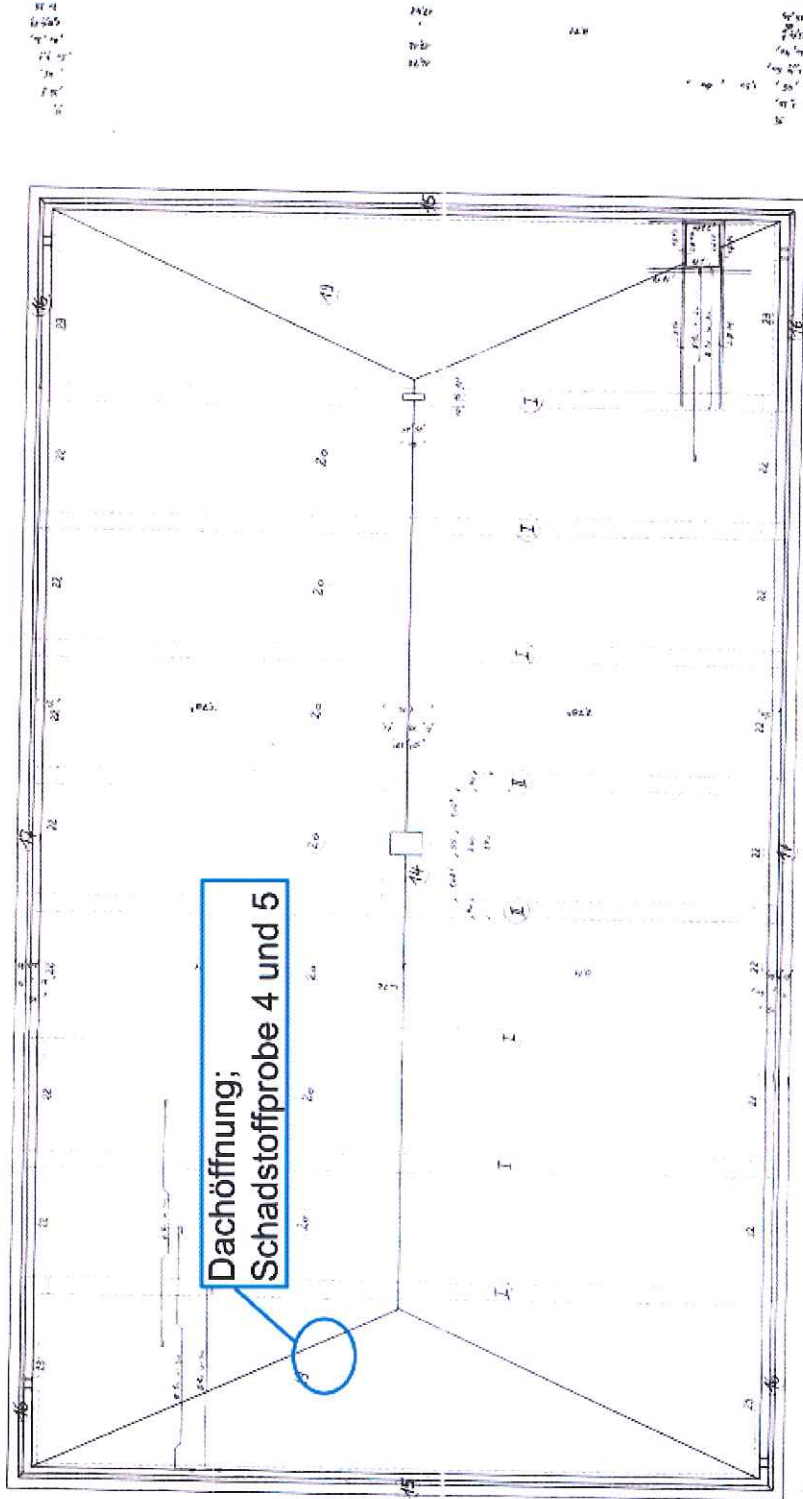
Grundriss Dach mit Entnahmestellen
